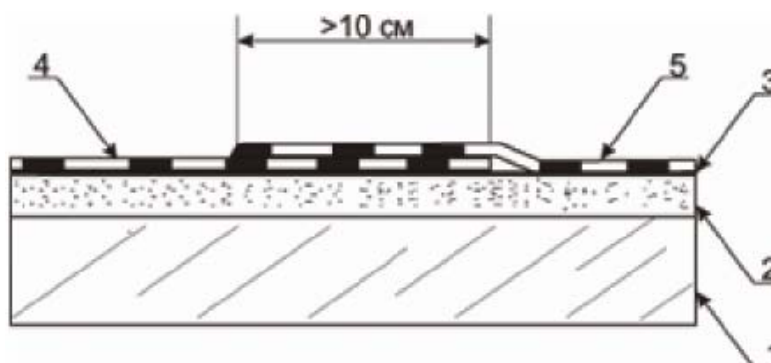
Перекрытие гидроизоляционных слоев на границе участков нанесения
